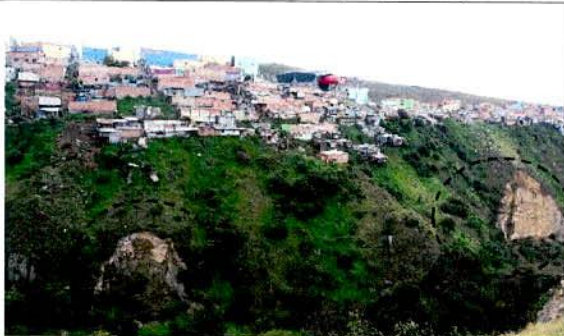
Entrega inadecuada de las aguas residuales directamente al terreno, carentes de un sistema de conducción que evite la infiltración de estas en el subsuelo.
